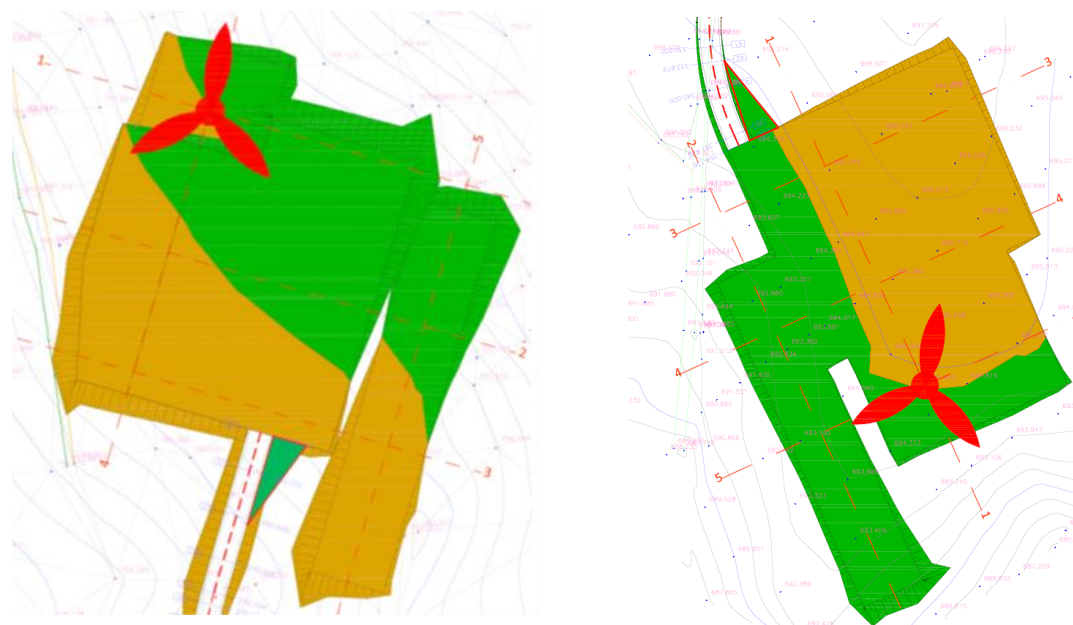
A destra la Planimetria BCN01, a sinistra la planimetria BCN04
